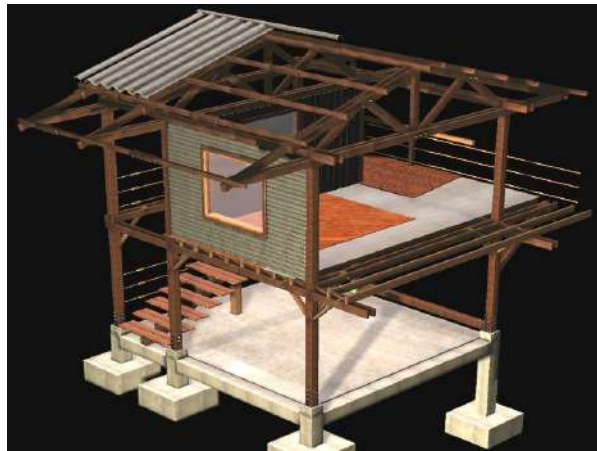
sistema constructivo madera con uniones empernadas contemporáneo. MADECO
